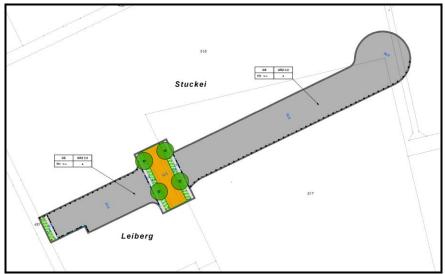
Lageplan, Bebauungsplan 1. Änderung V13 "Gut Nierhof II", ohne Maßstab
